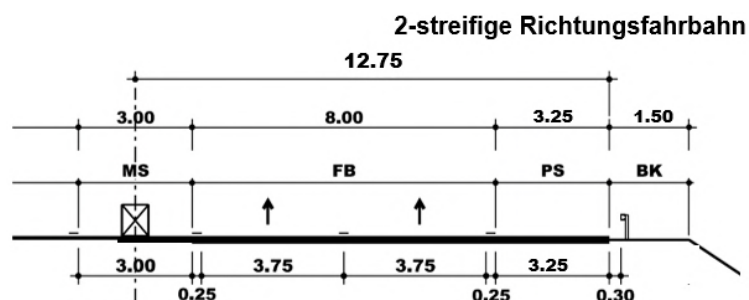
Profilo standard secondo la RiLi 11001:2017 kp 5.1.1
